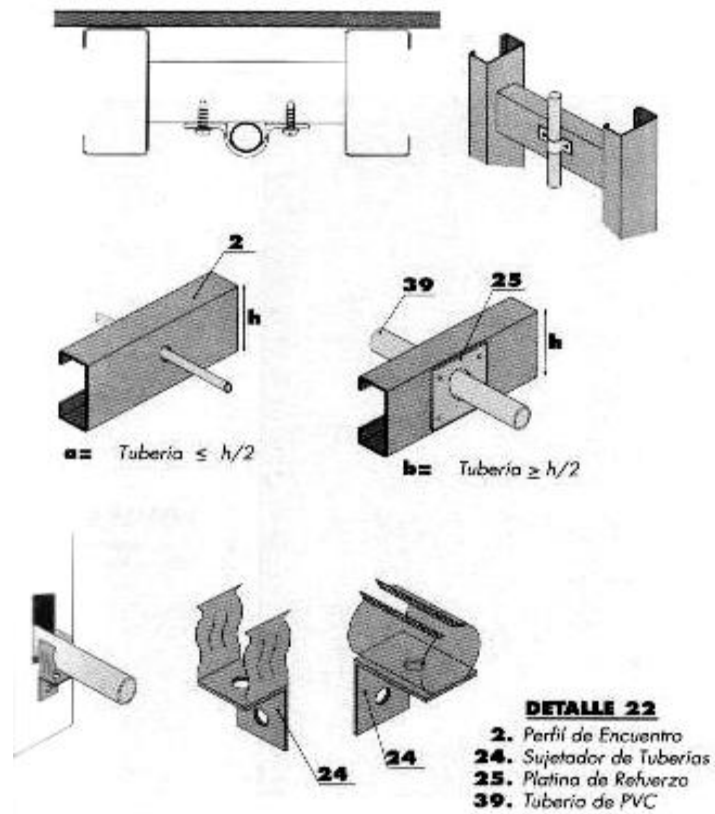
Elementos para fijar las instalaciones sanitarias con los perfiles metálicos.
